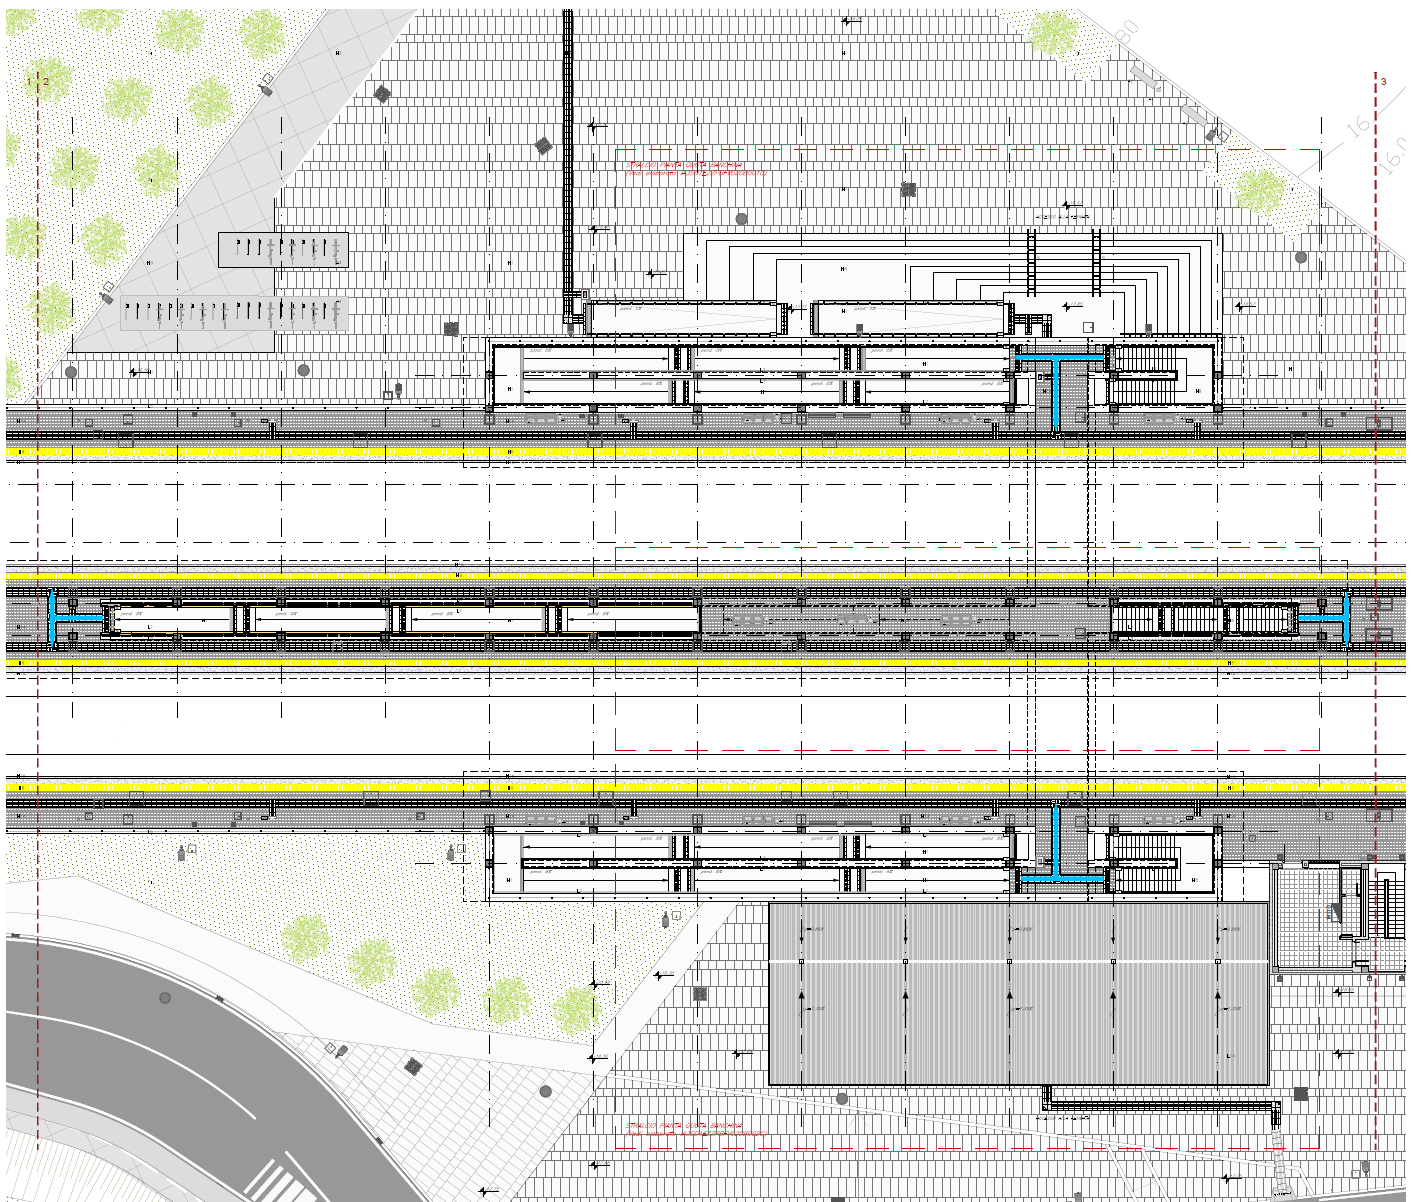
Pianta Quota Banchina con individuazione del PPO
